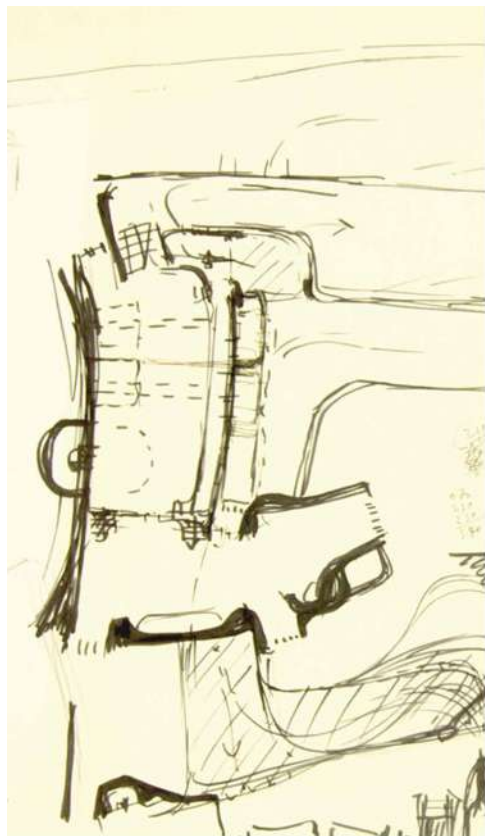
G. Michelucci, planimetria 1:1000. S.d.
